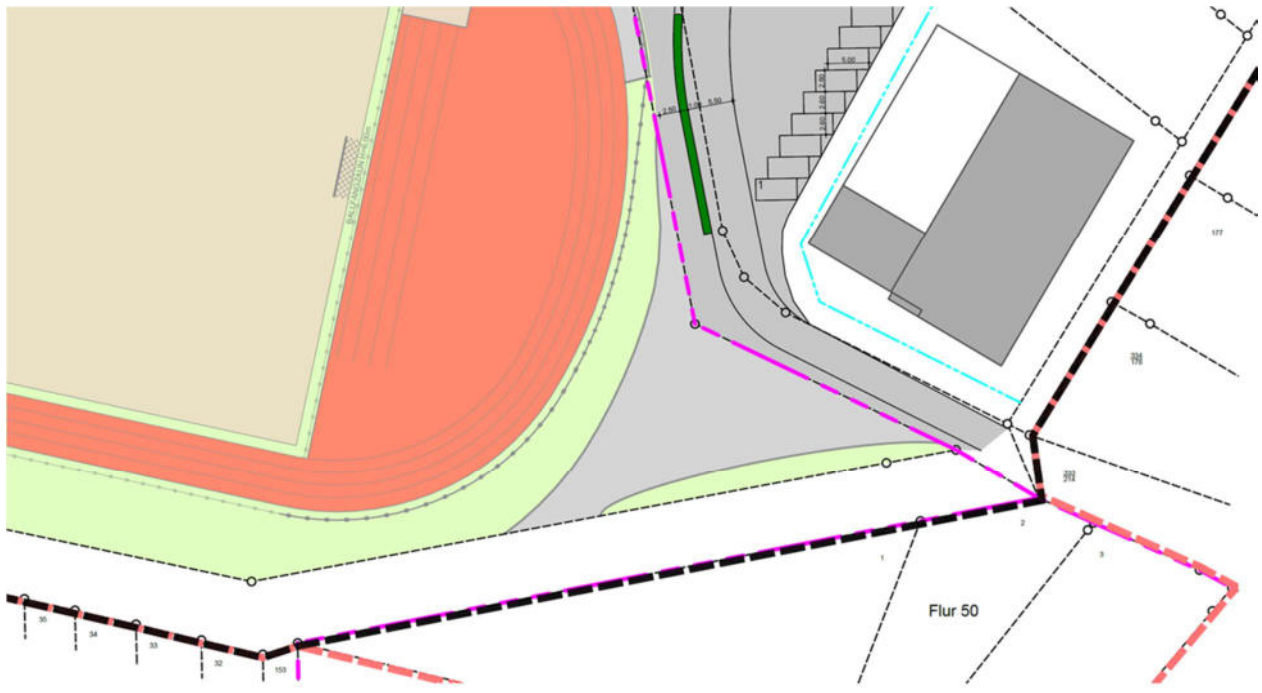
Lageplanausschnitt Beckenstandort Süd, Flurstücke 1, 2 und 3
